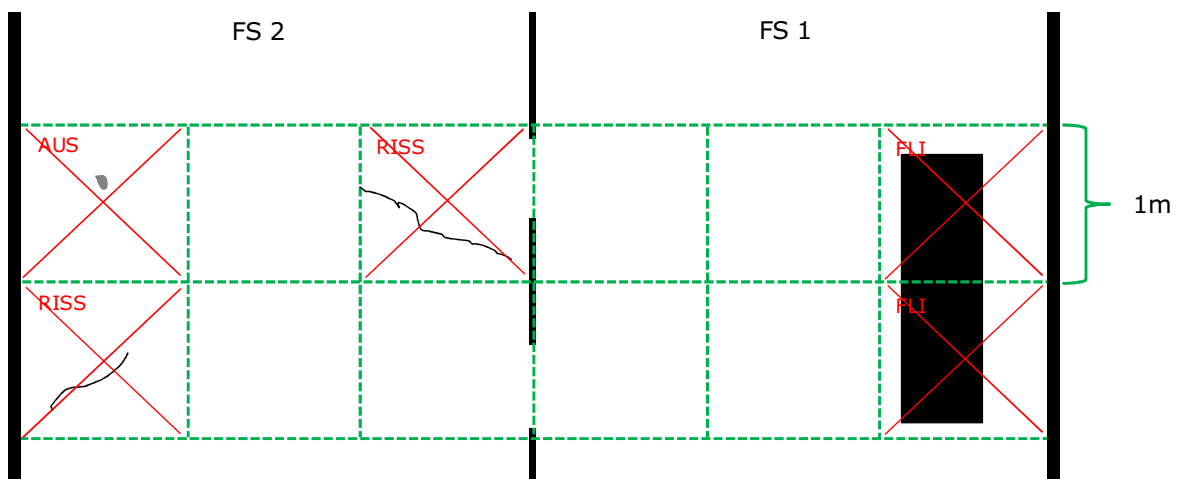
Auswerteschema zur Auswertung der Substanzmerkmale (Oberfläche) von Asphalt
